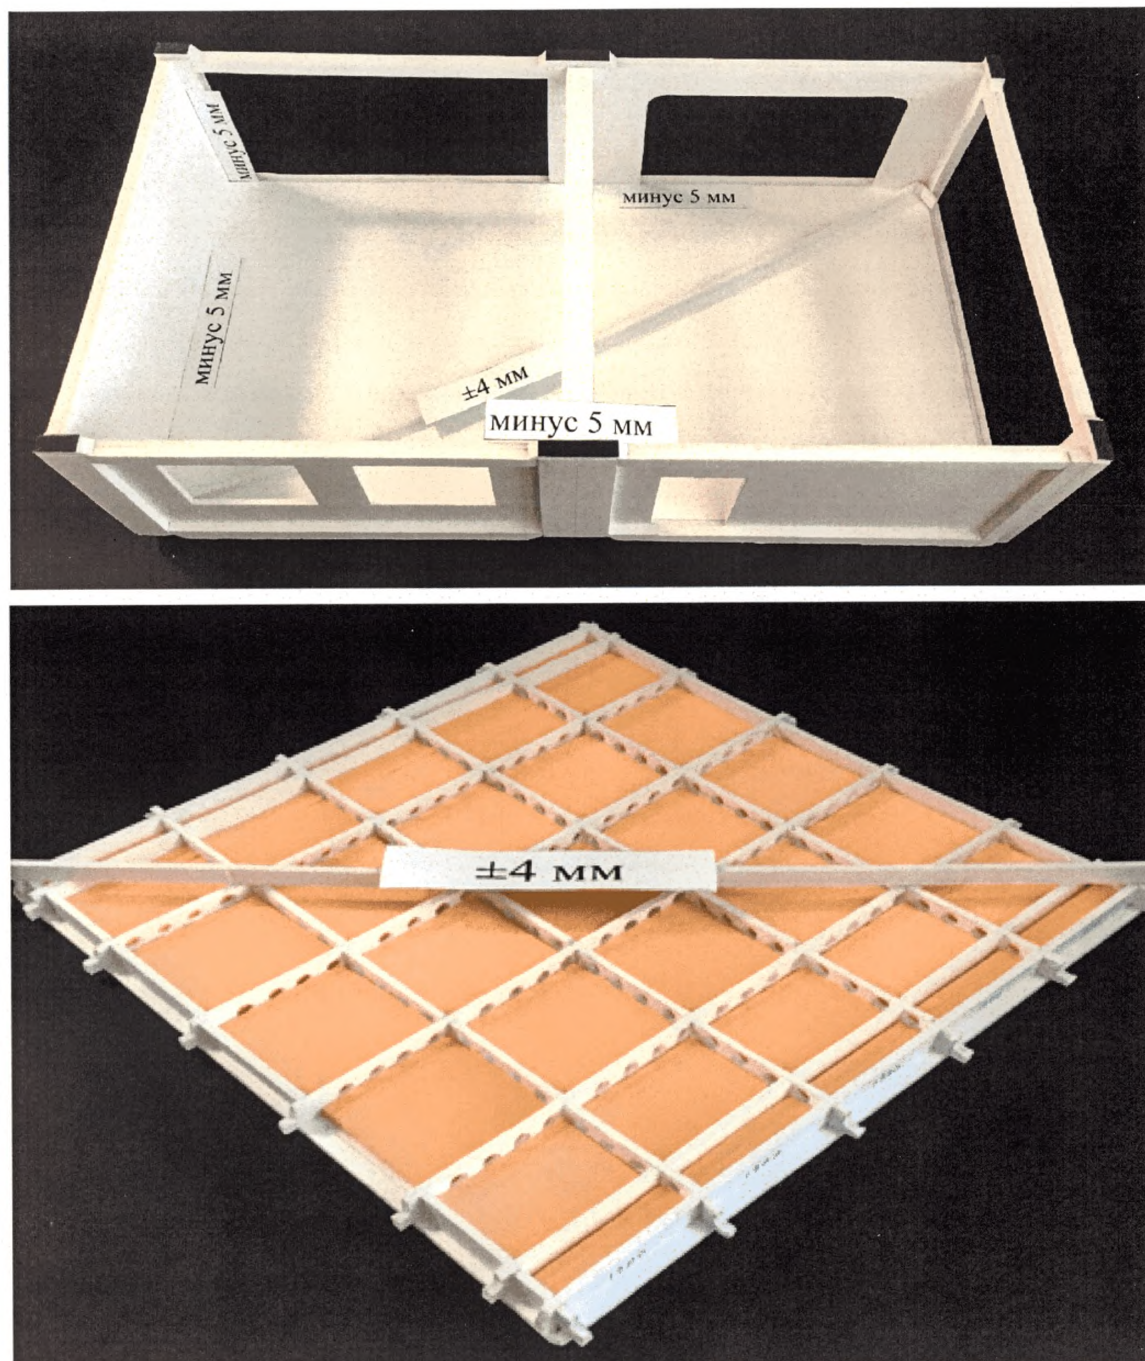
Допуски на отклонения собранного модуля, верхней и нижней плит
